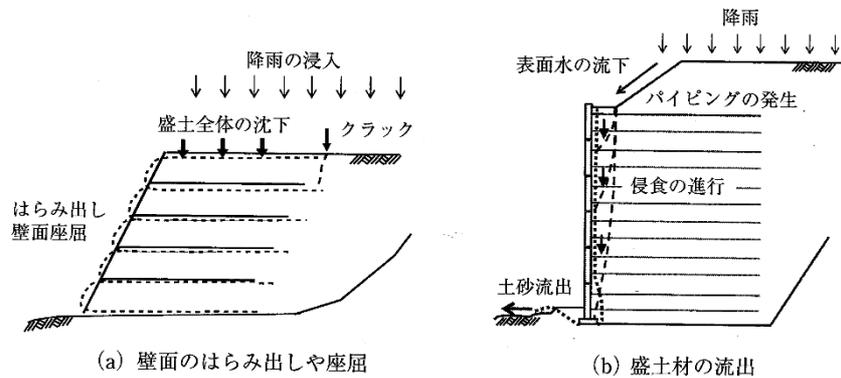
水の浸入による補強土壁の変状事例⁸⁾
